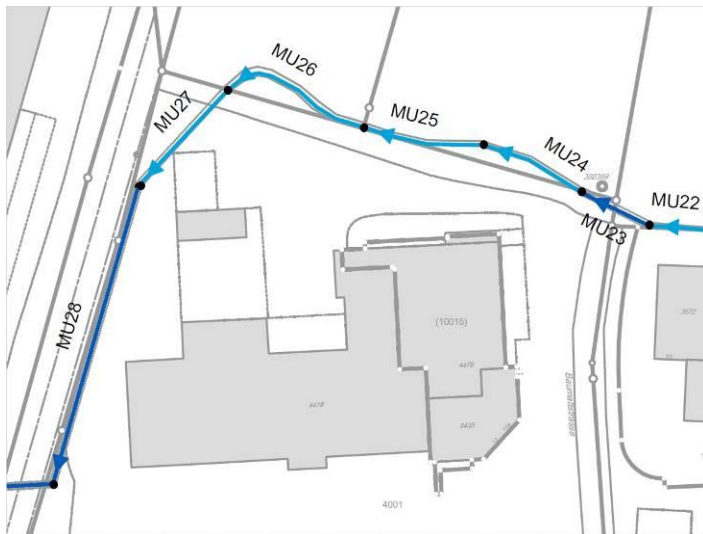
; Ausschnitt aus Plan Haltungen GEP (Genereller Entwässerungsplan) Berechnung (ohne Masstab)
